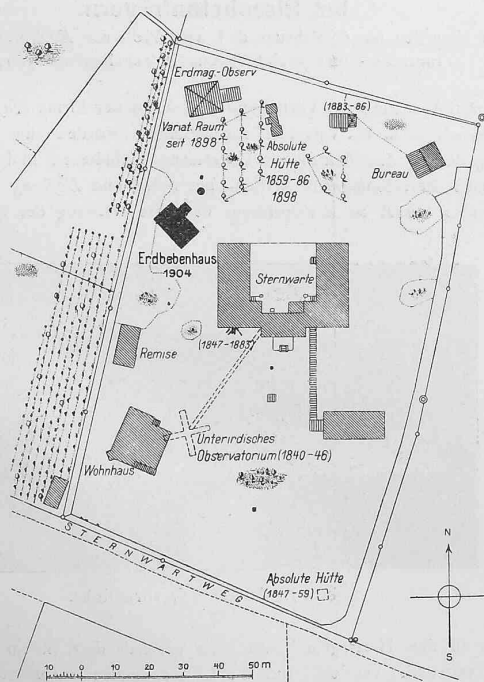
Der Sternwarte-Garten mit dem Erdbebenhause in München. — Lageplan. — Masstab 1 : 2000.
